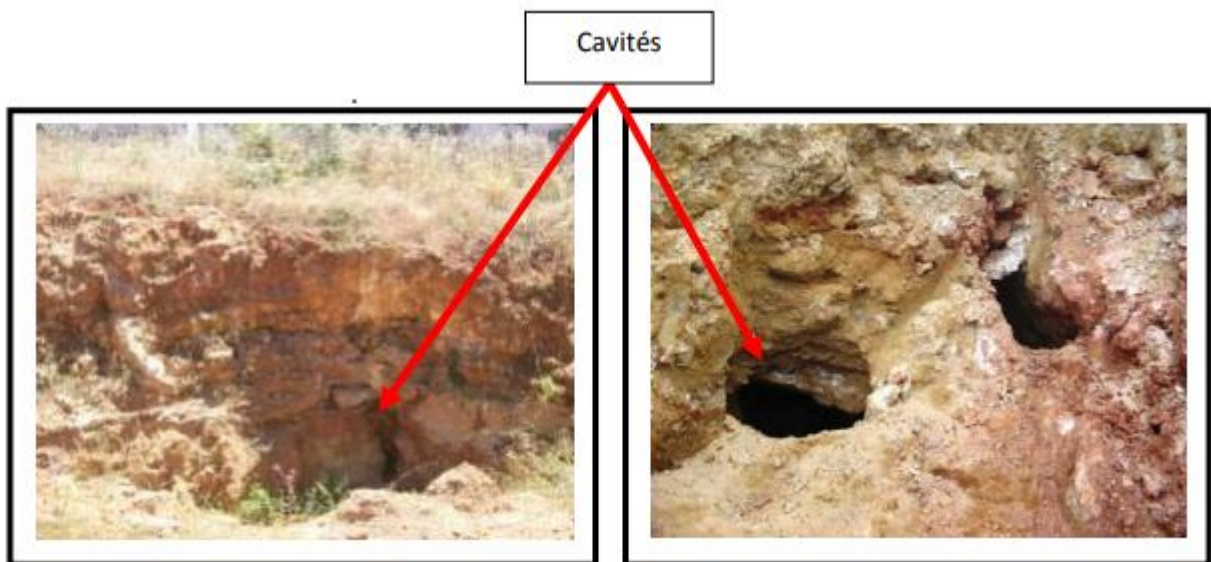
Exemples de cavités dans le site d'AïnBenian.
